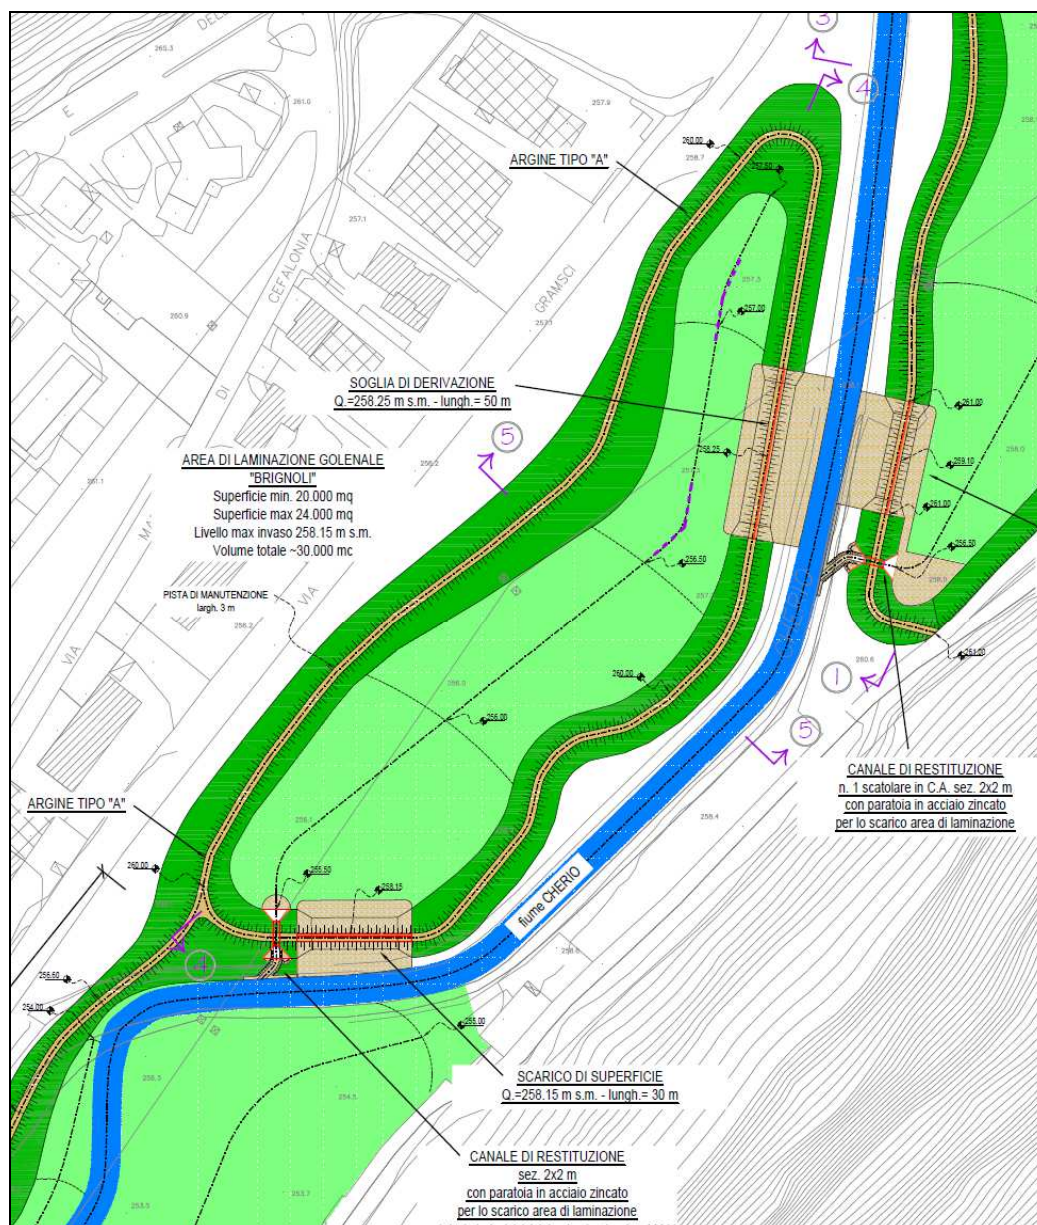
Planimetria dell'area di laminazione golenale "Brignoli"
